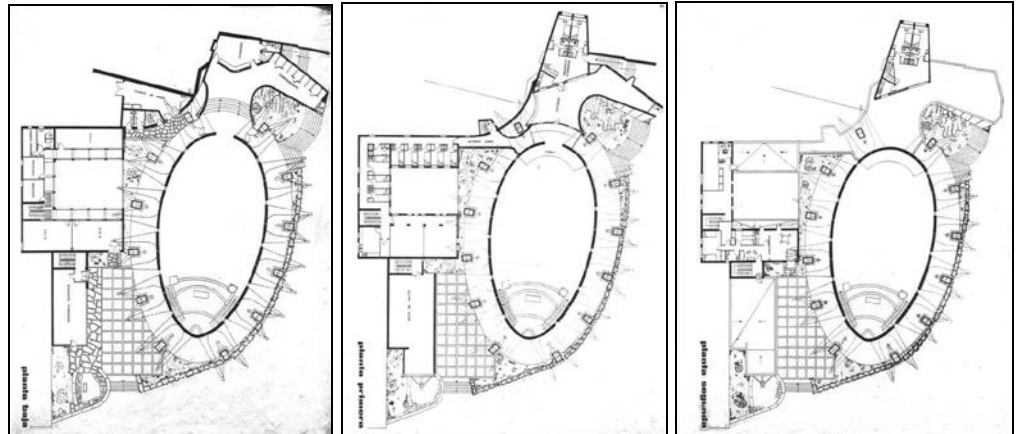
Plantas 0, 1 y 2 de la Parroquia de Ntra. Sra. de Loreto de Jávea (Inf. Const. 1968)
